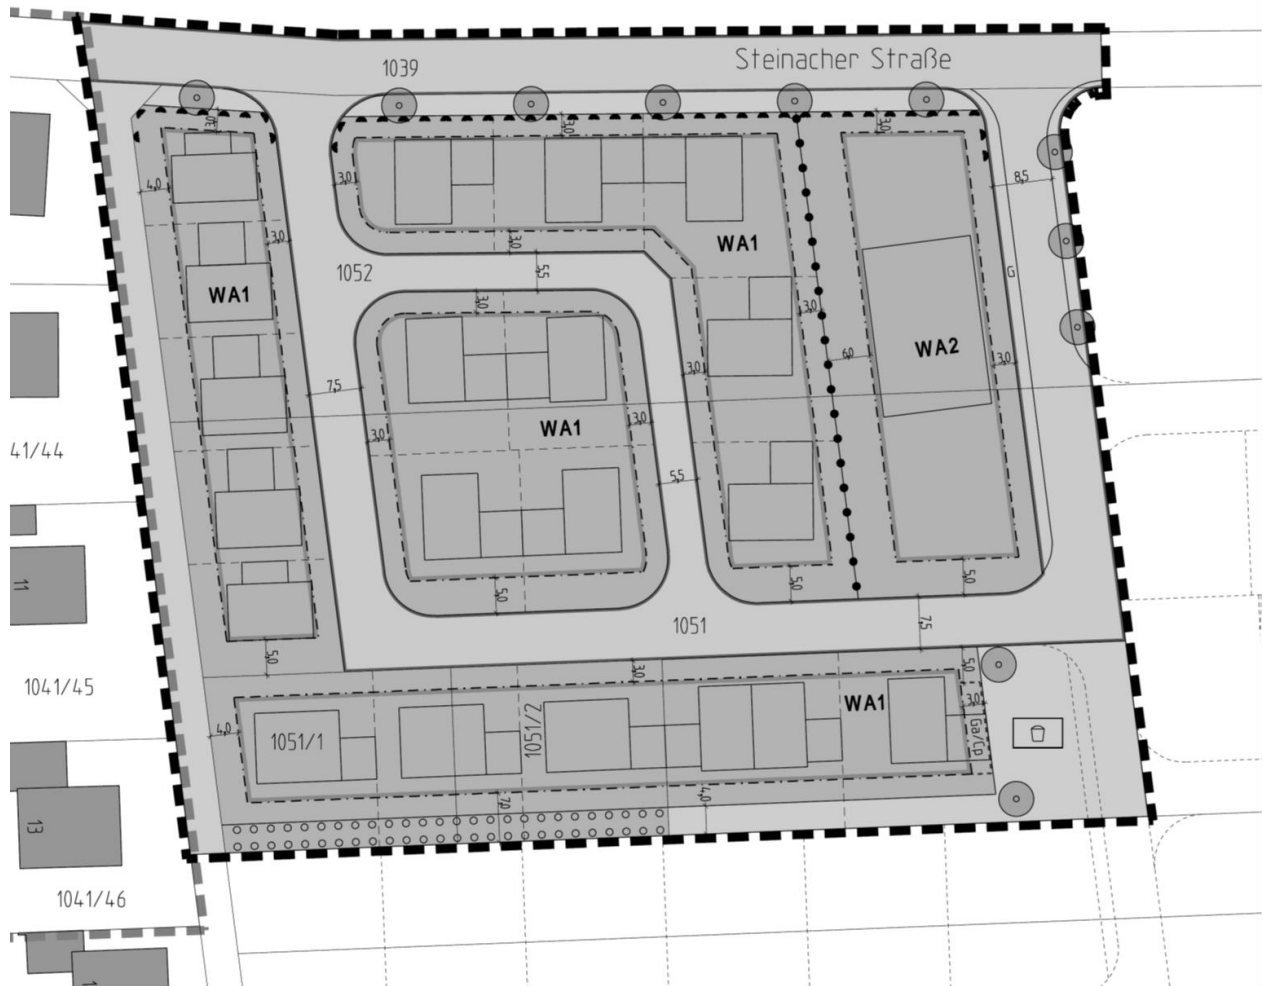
Planauszug, Bebauungsplan Nr. 34 „Östlich der Nebelhornstraße“
